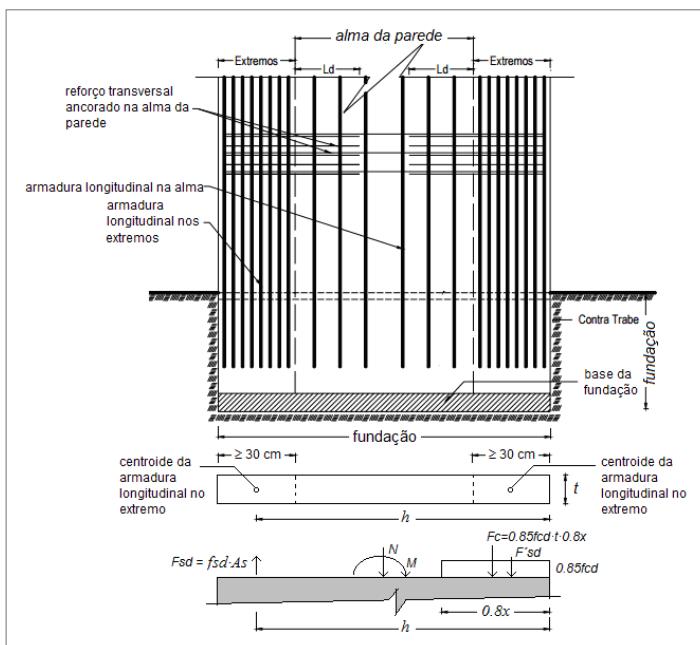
Distribuição da armadura nos extremos e alma e modelo de cálculo de pilar parede retangular.
